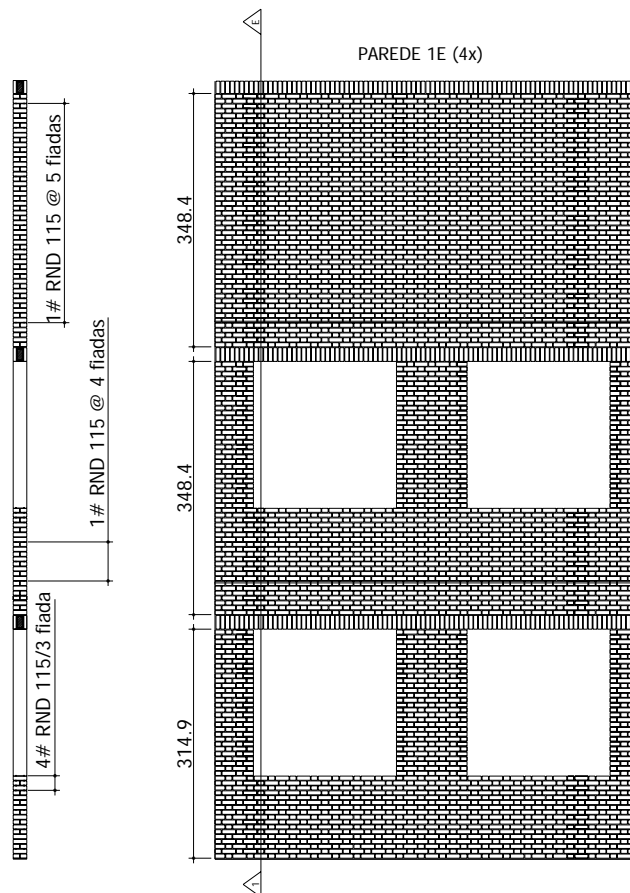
Elevação e seção transversal de uma parede externa.
